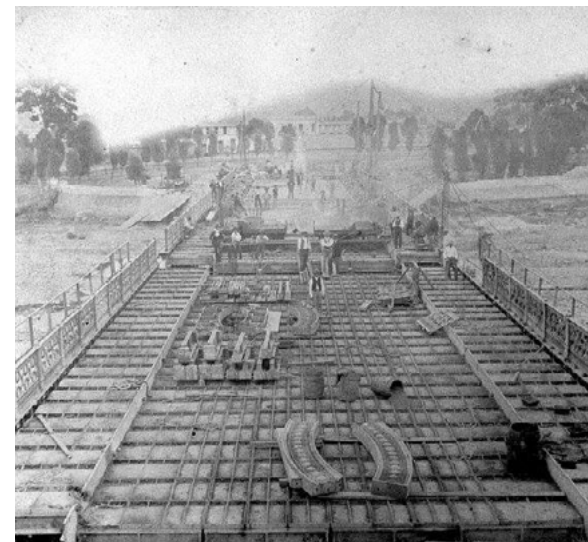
Puente Balta en construcción, al fondo se ve la Alameda de Acho
